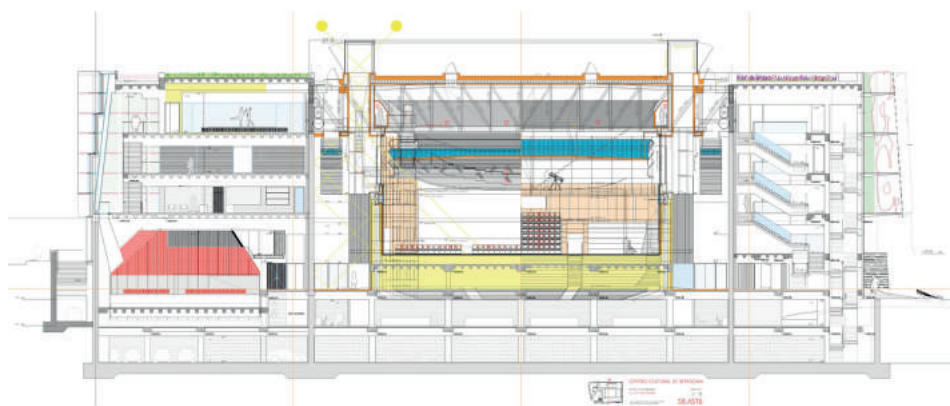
Plano de sección por la sala, danzas y conservatorio de música.
